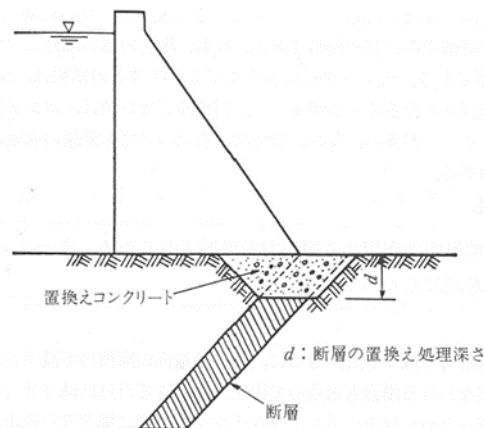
堤体の下流端付近の断層のコンクリートによる置換え処理
